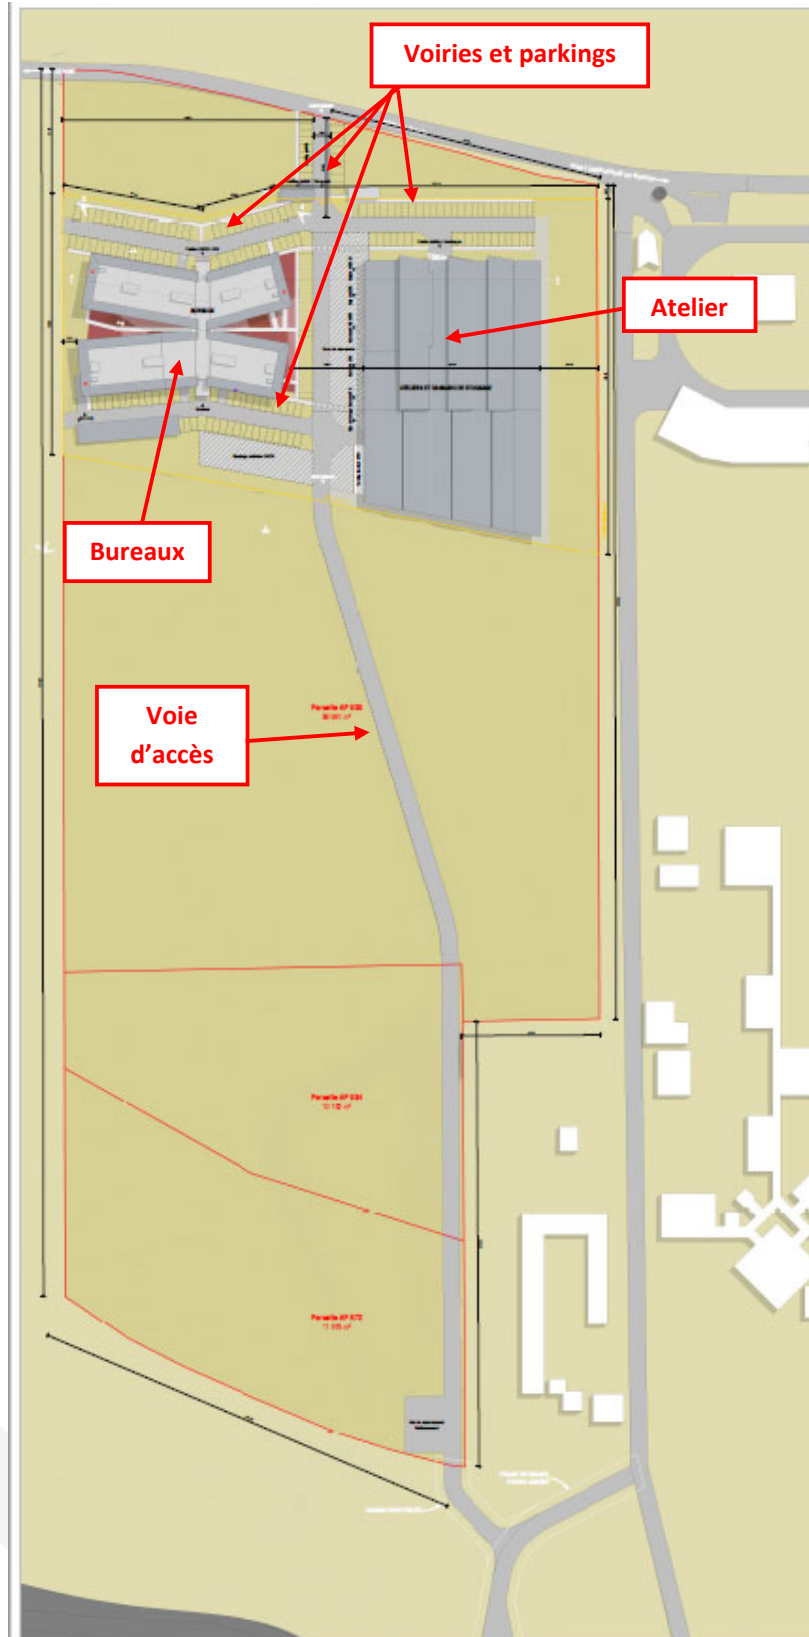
Plan de masse, version APD (Source : Groupement maitrise d'oeuvre)
